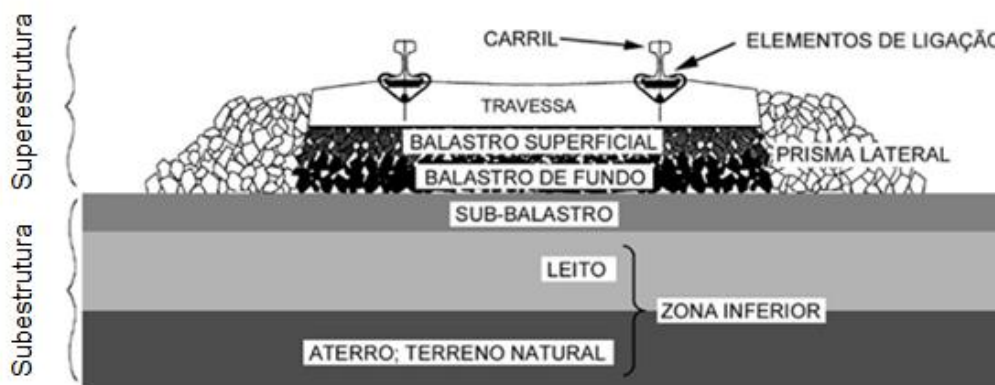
Superestrutura e Subestrutura adaptado de [10]
